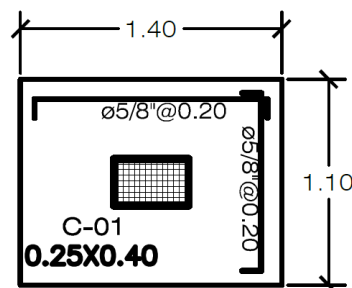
Diagrama de acero de la zapata aislada del módulo 01 ubicada entre los ejes "3"- "K"
